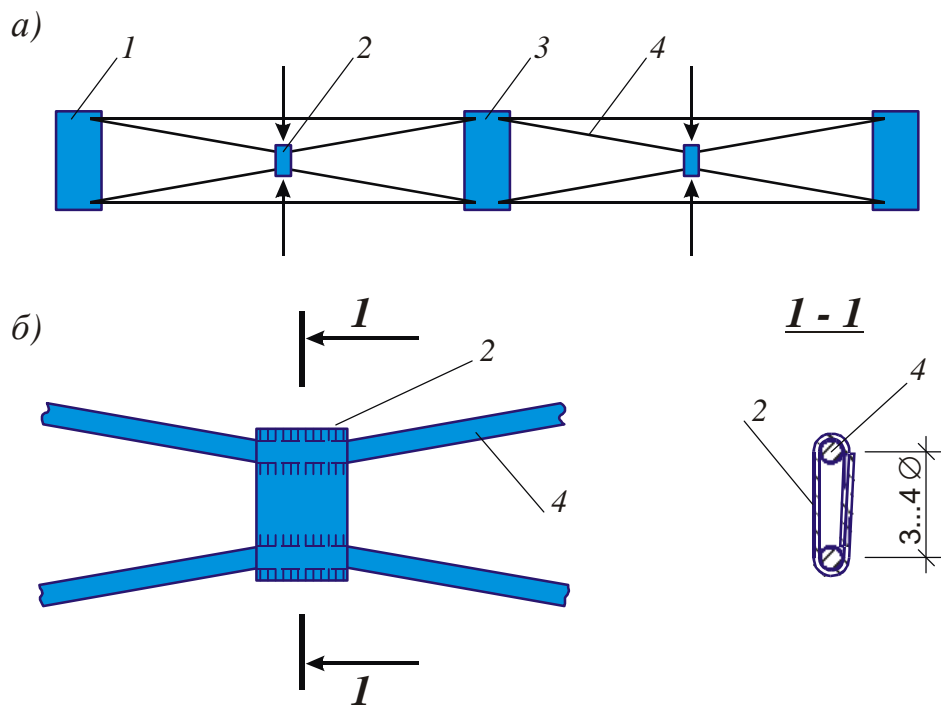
Установка дополнительных затяжек на железобетонную балку:
